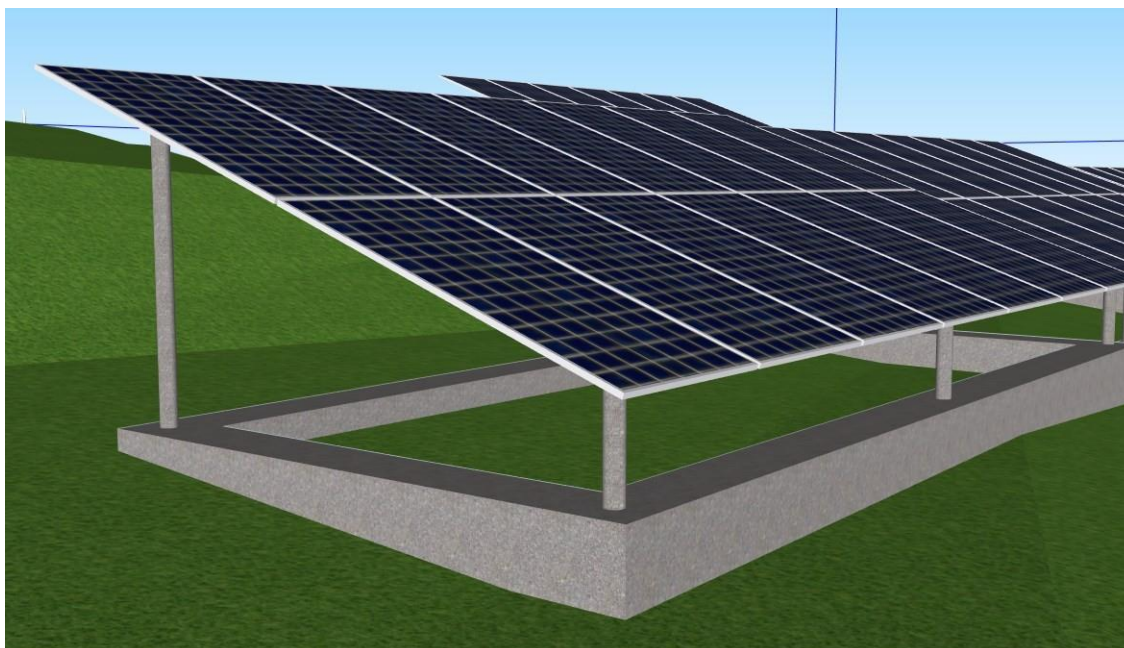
Representação 3D do sistema de fundação proposto mostrando a estrutura de fundação enterrada no terreno do aterro.
